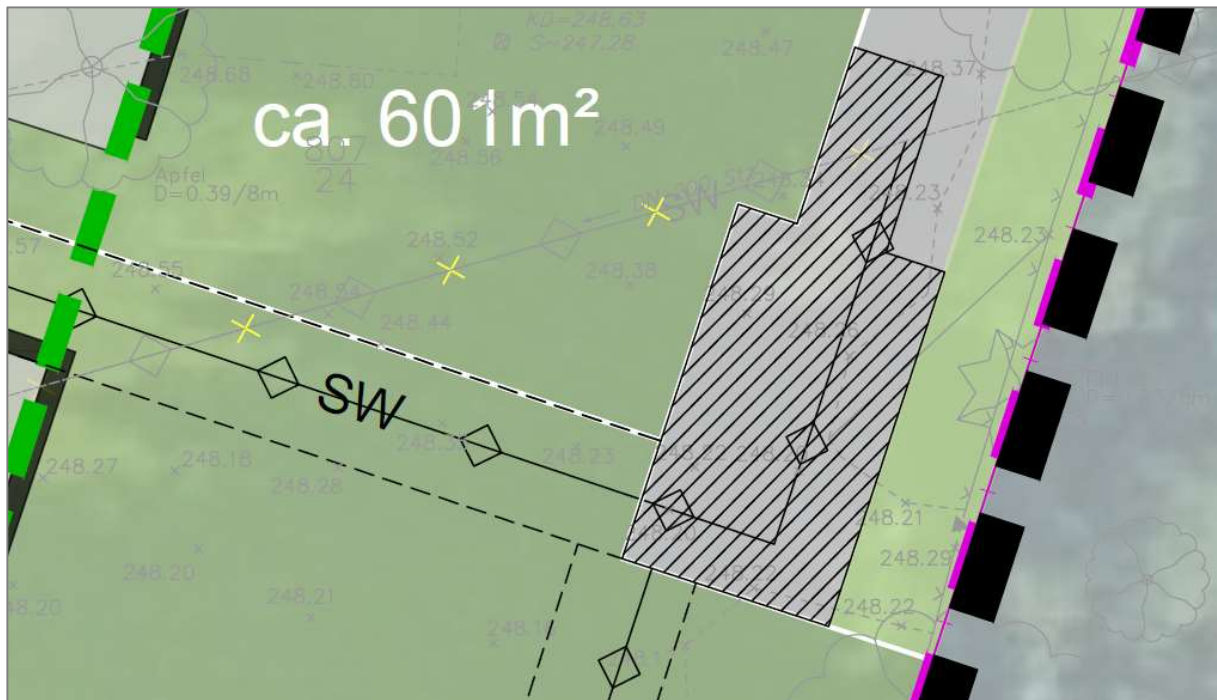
Ausschnitt des Baukonzepts mit Darstellung der Bewegungsfläche gemäß DIN 14090
